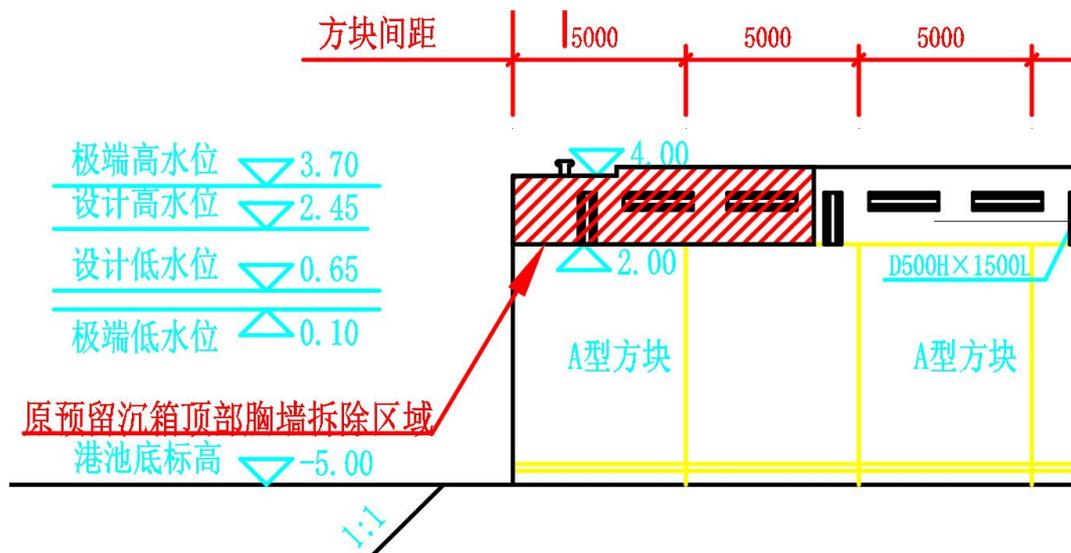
原预留沉箱顶部胸墙立面图
